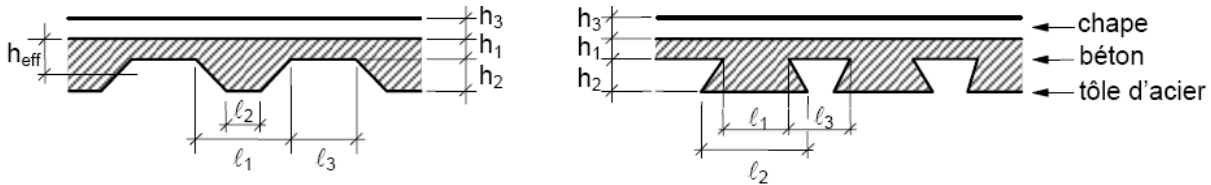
Epaisseur efficace d'une dalle mixte [EC4 06]
